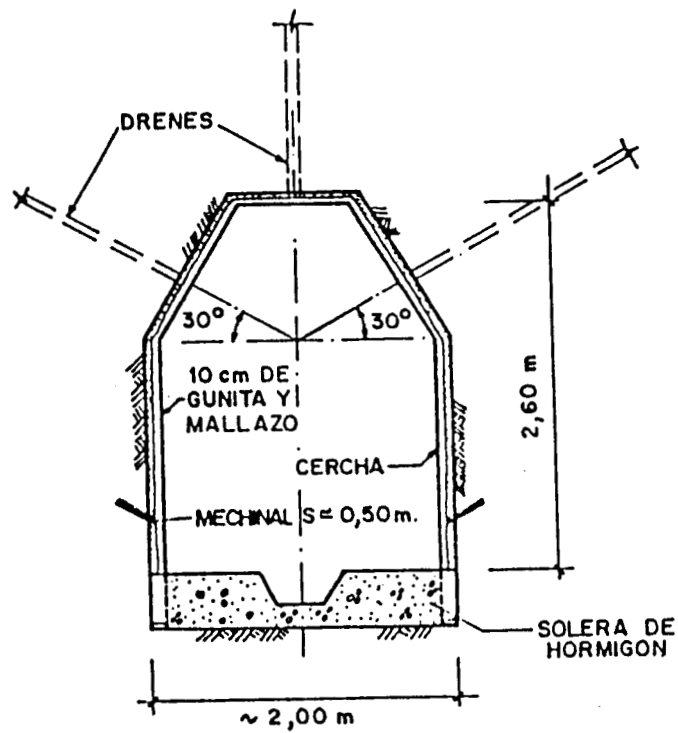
GALERIA DE DRENAJE (R. ORTIZ ET AL.)
